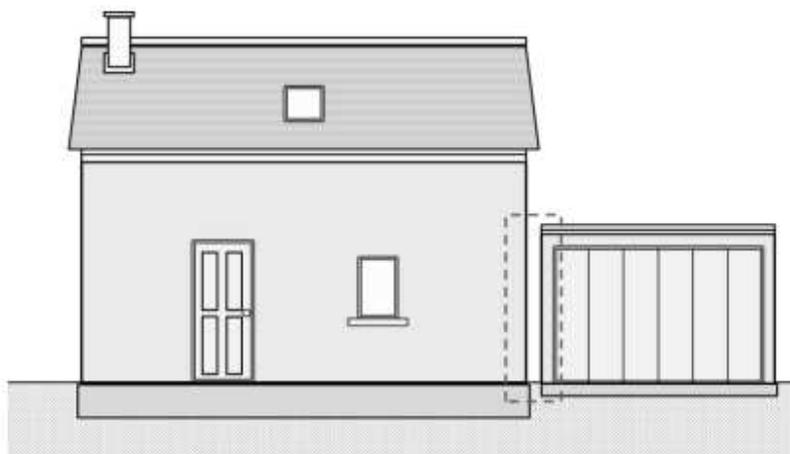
exemple de création d'un joint vertical d'affaissement d'un garage accolé à une maison individuelle
